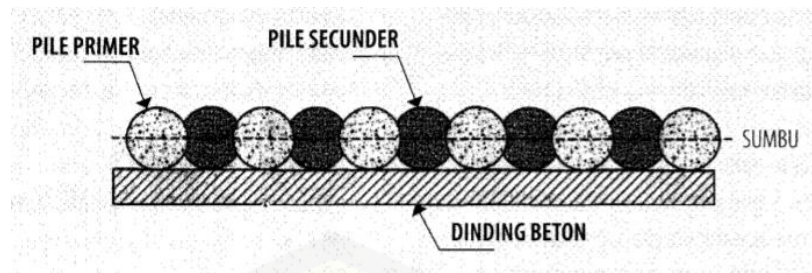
Secant Pile* Dengan 1 Sumbu
